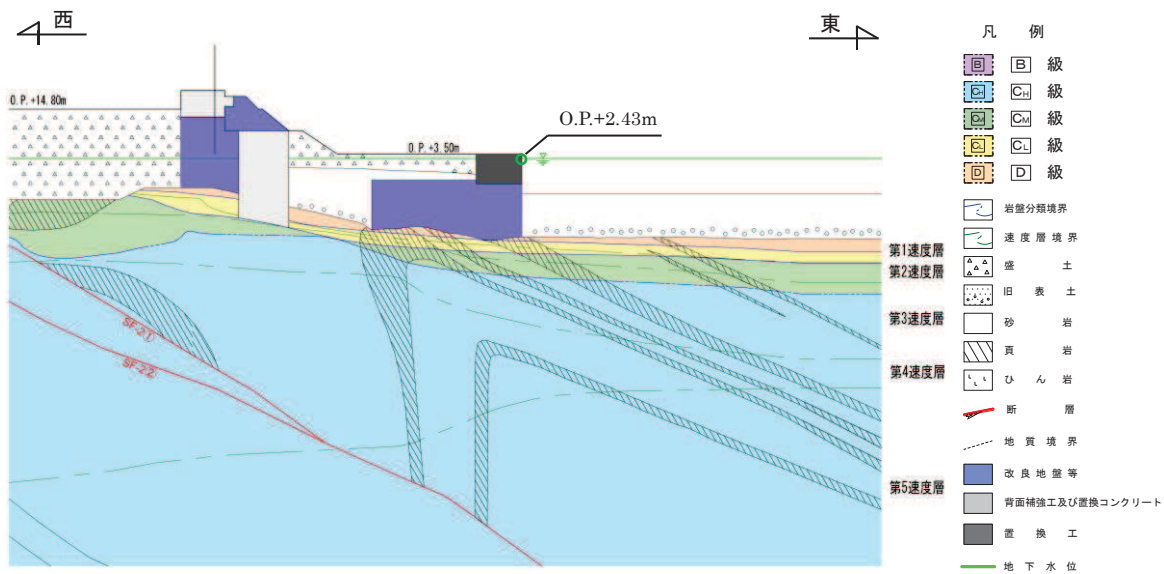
前面護岸 評価対象地質断面図 (A-A 断面)
